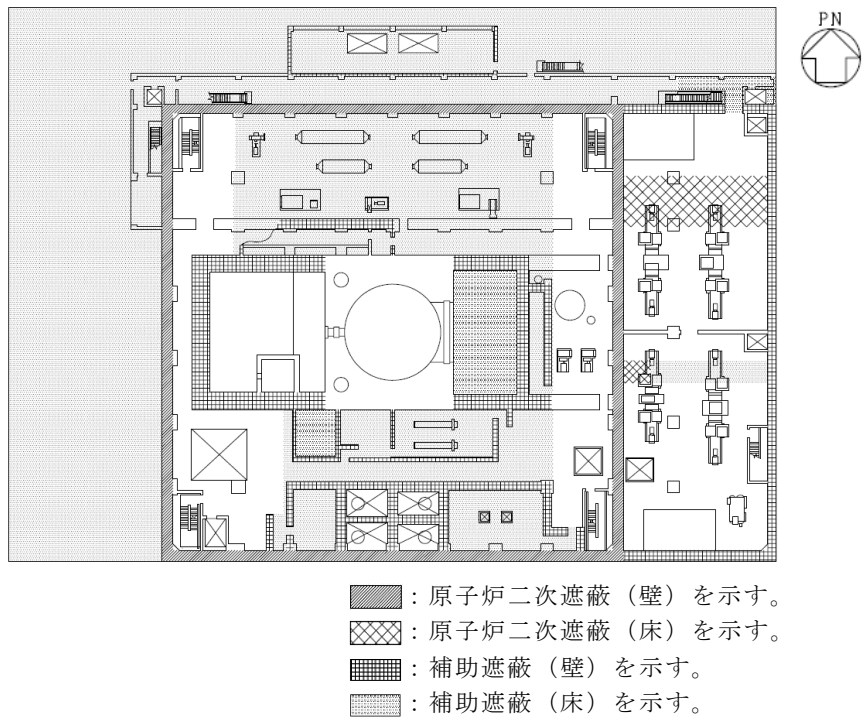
(8) 原子炉二次遮蔽及び補助遮蔽（原子炉建物）の範囲の平面図
